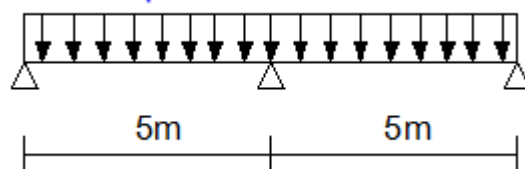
schéma statique de la poutre reposant sur (03) appuis.
